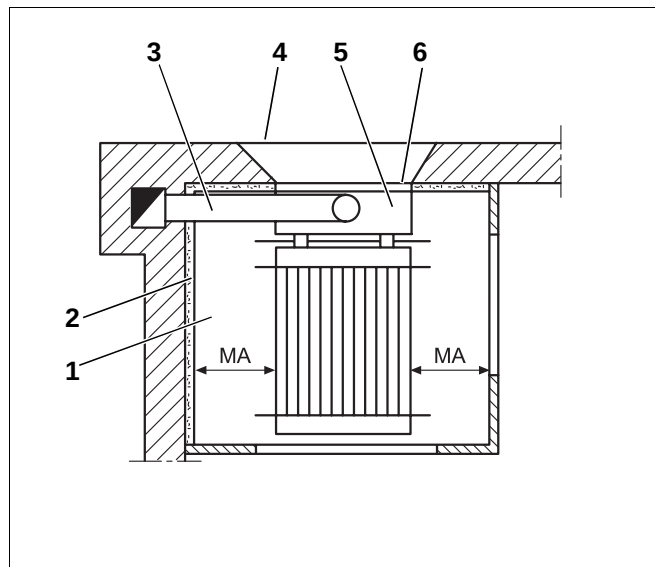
Montageabstand Gasheizeinsatz Draufsicht
